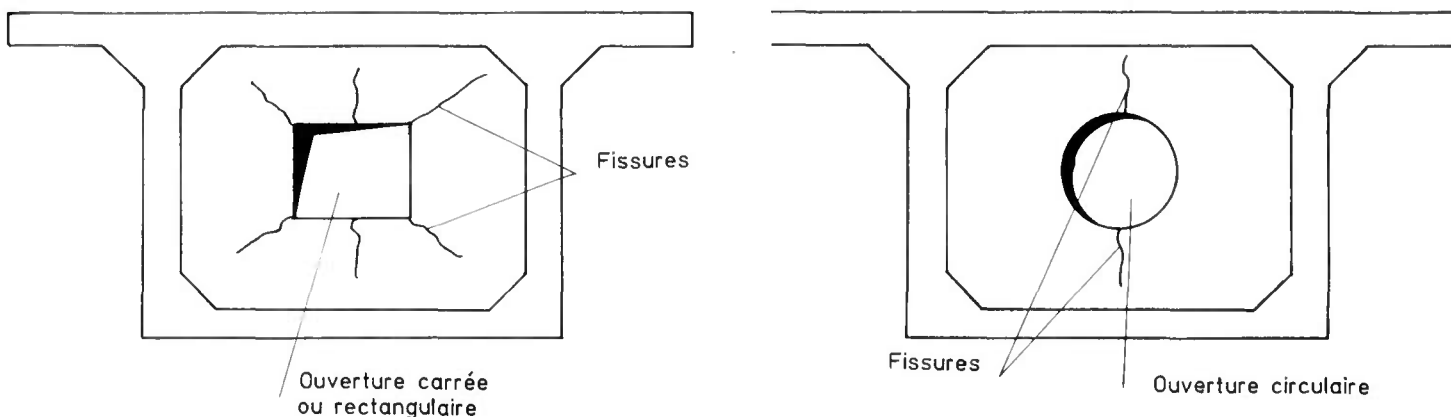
Fissuration d'une entretoise au voisinage d'une ouverture.
